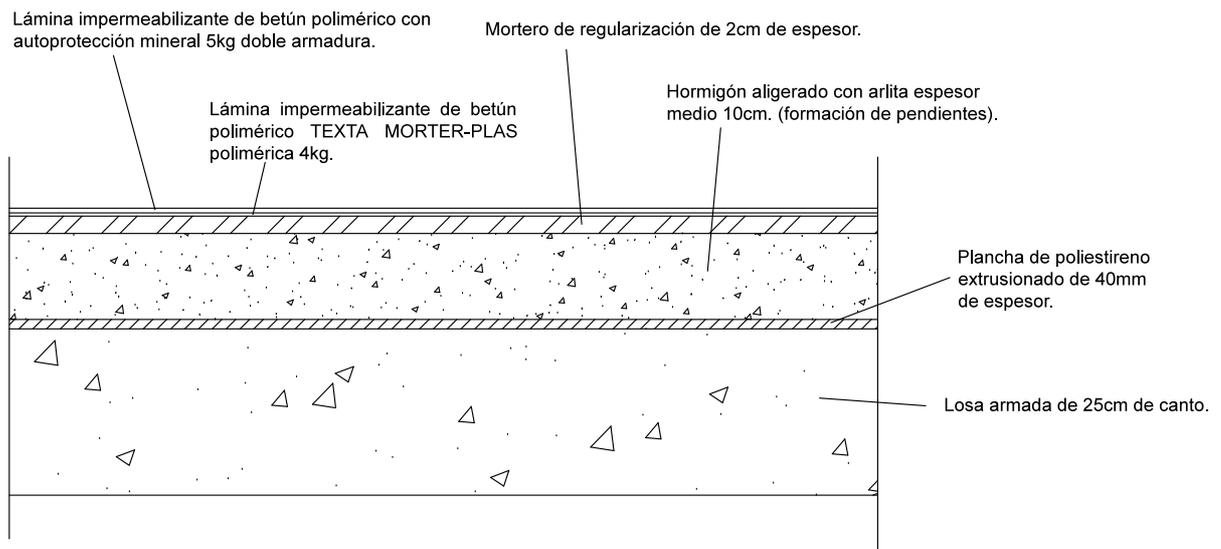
Detalle constructivo cubierta plana no transitable con acabado de lámina autoprotegida (acceso, casetón escalera y ascensor).
